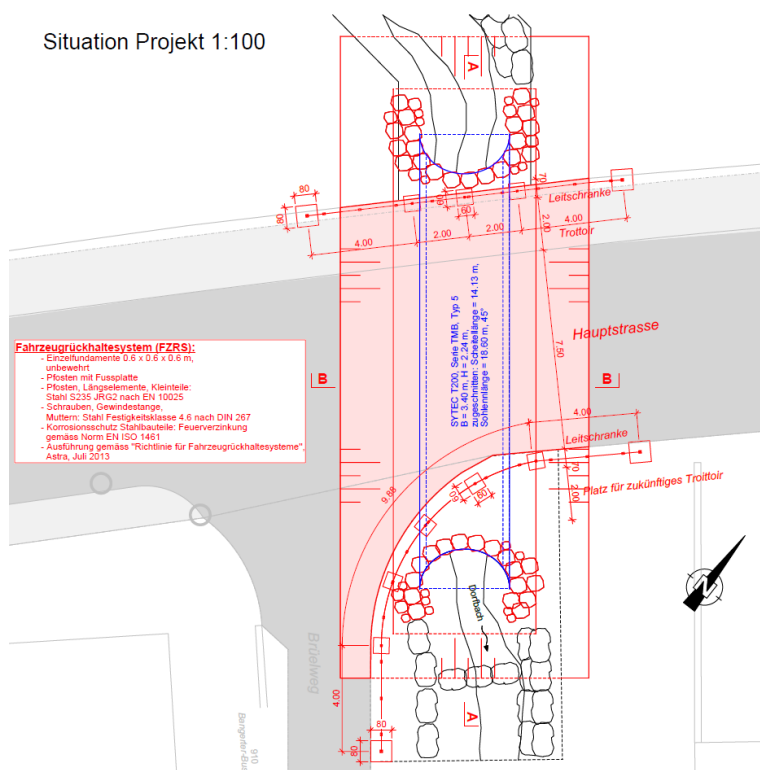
Grundriss Durchlass Hauptstrasse (Detailplan Durchlass Hauptstrasse, Plan-Nr. 6.285/33.541 A, Beilage 2.9, Stand 21.10.2016).
